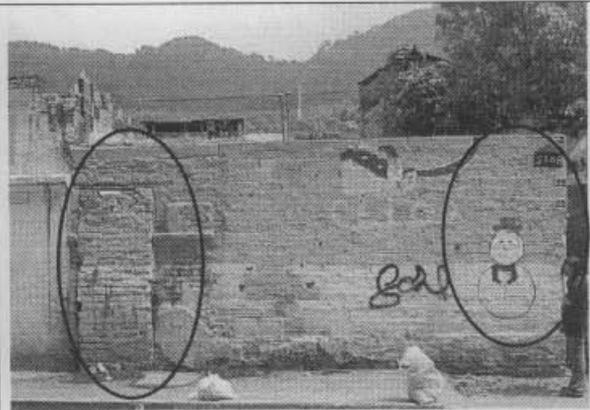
Muro de fachada suelto, sin ningún tipo de amarre estructural y con deficiente calidad de construcción.
